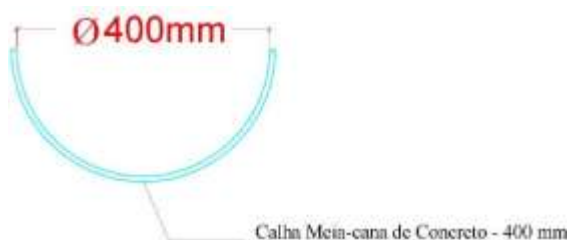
Detalhe do sistema de drenagem pluvial nas trincheiras.
